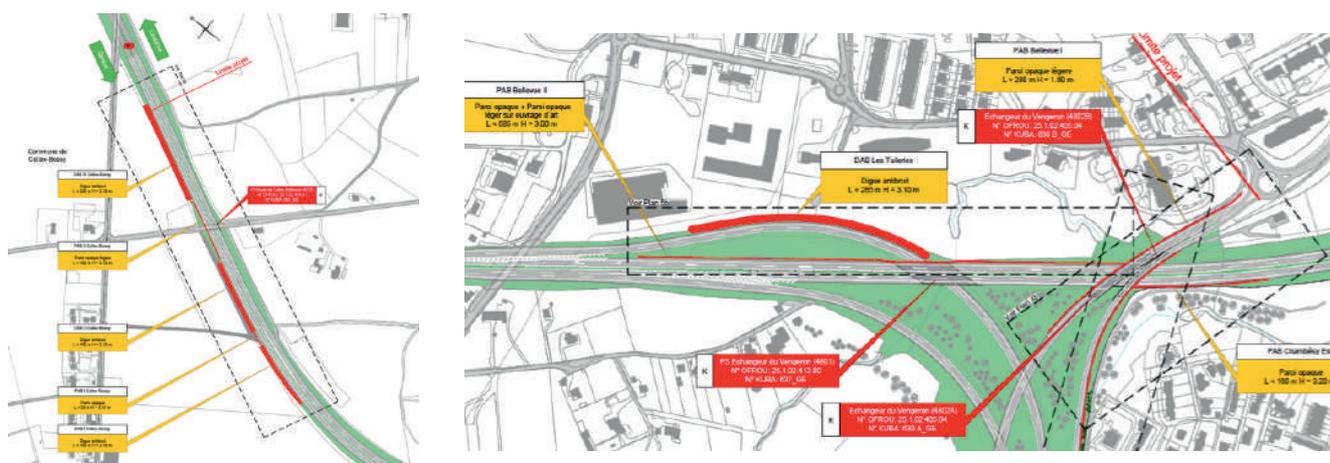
Localisation des projets d'assainissement du bruit autoroutier (OFROU, août 2016)
